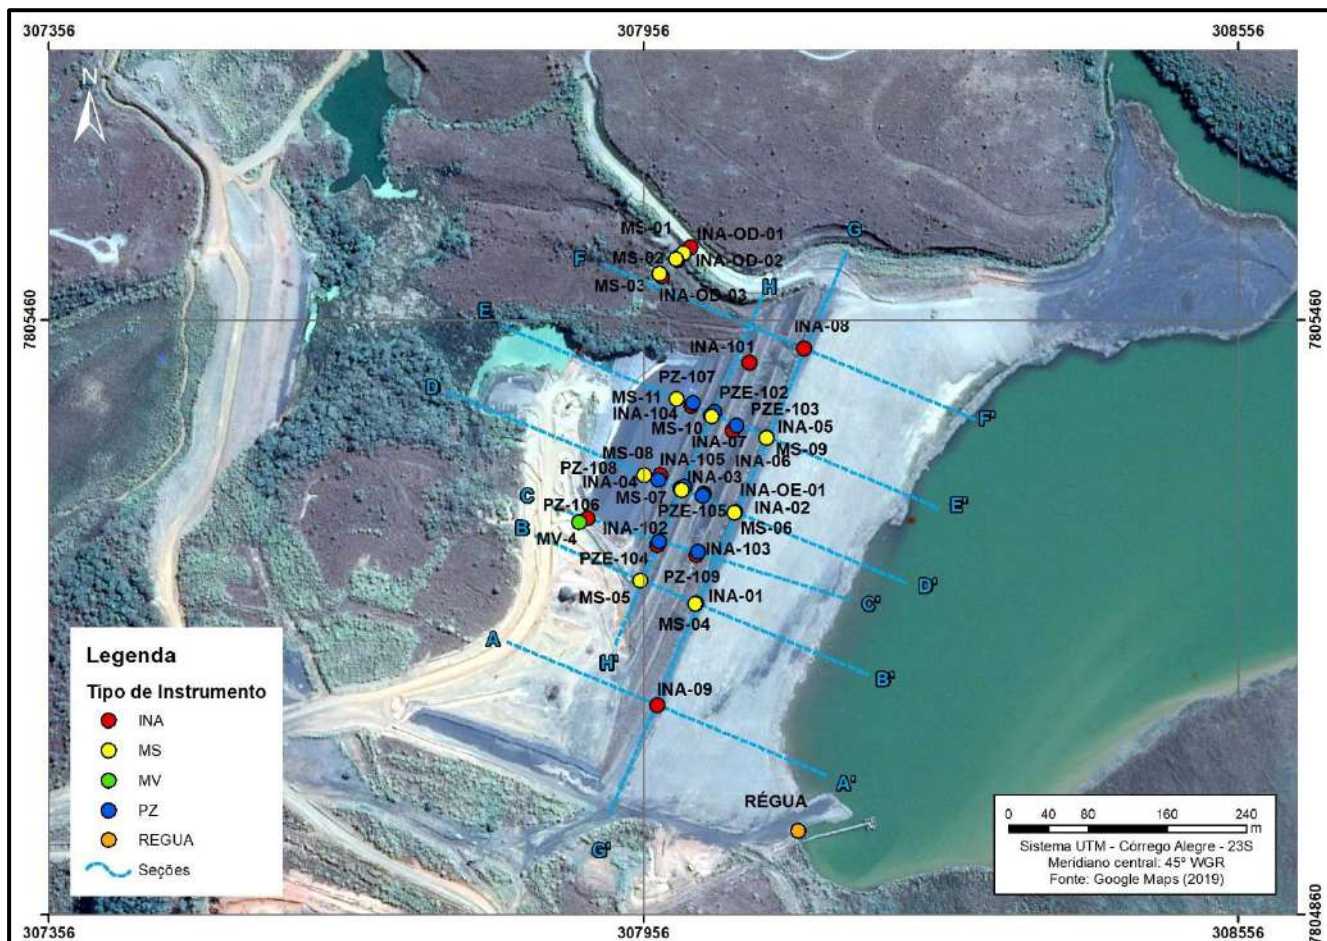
Planta com locação da instrumentação – Barragem BR
